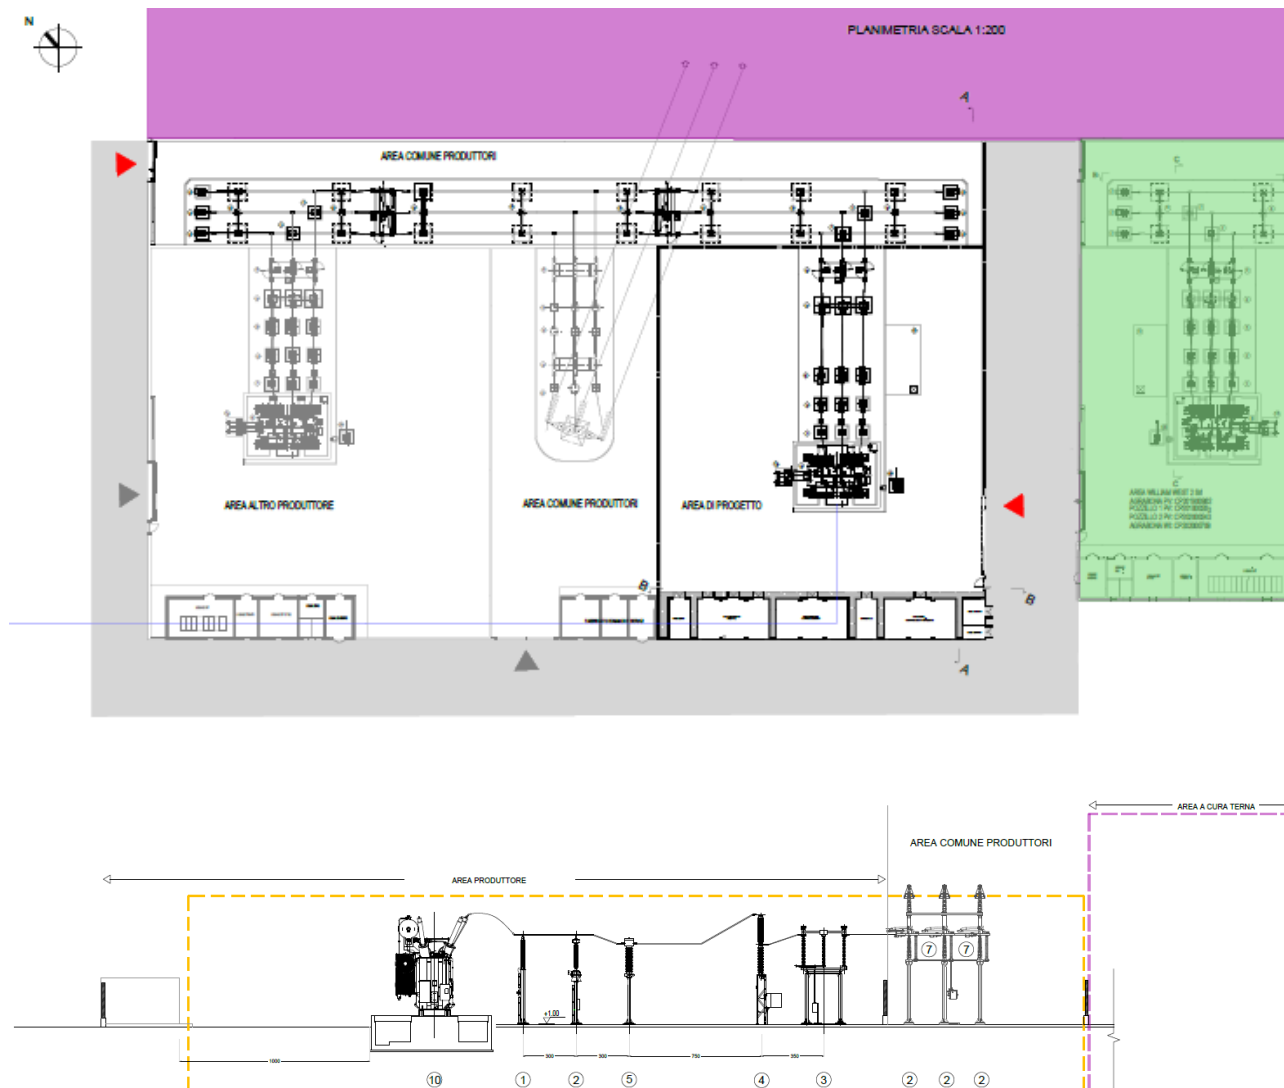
Planimetria SSE con particolare ubicazione macchina elettrica
